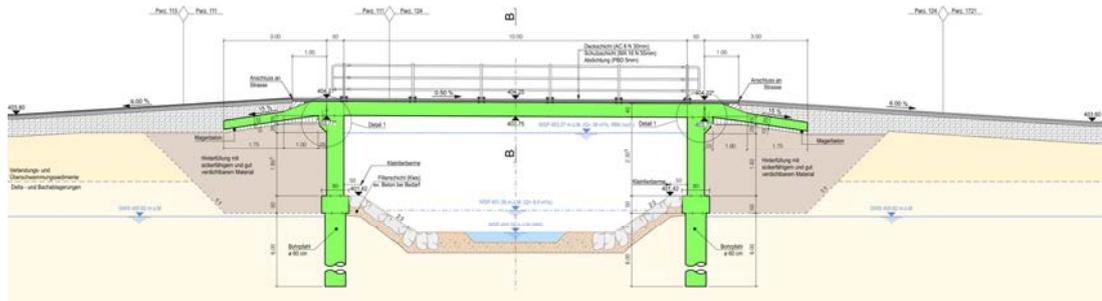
Vertikale Linienführung Brücke Kobelstrasse, Littenbach
